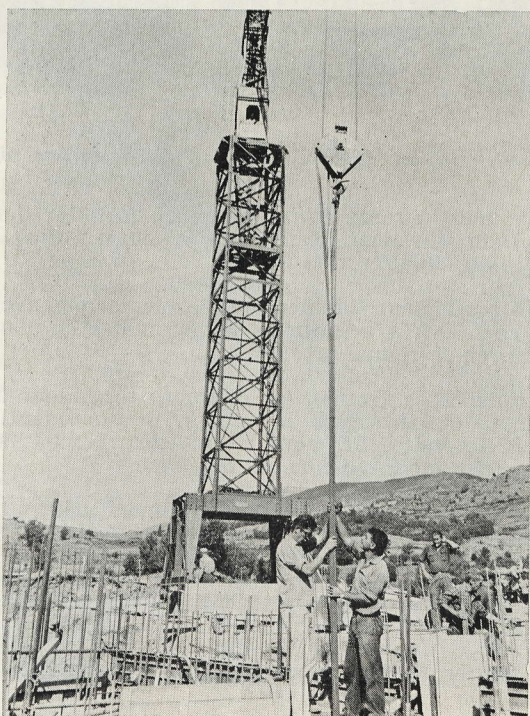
Mise en place d'un câble d'ancrage — mur porteur Est.
